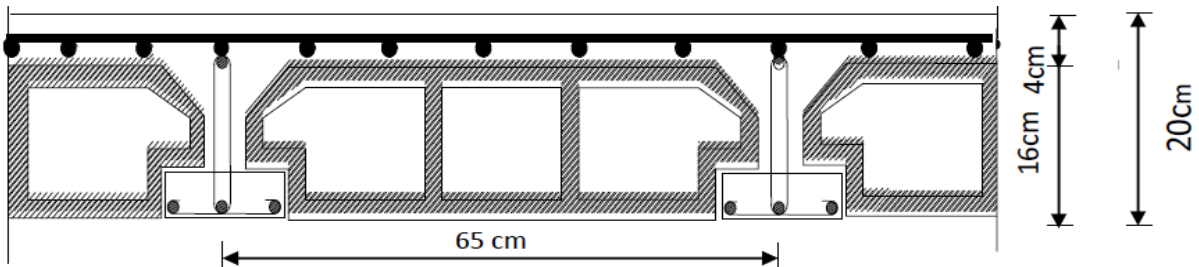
Coupe transversale d'un plancher en corps creux.
